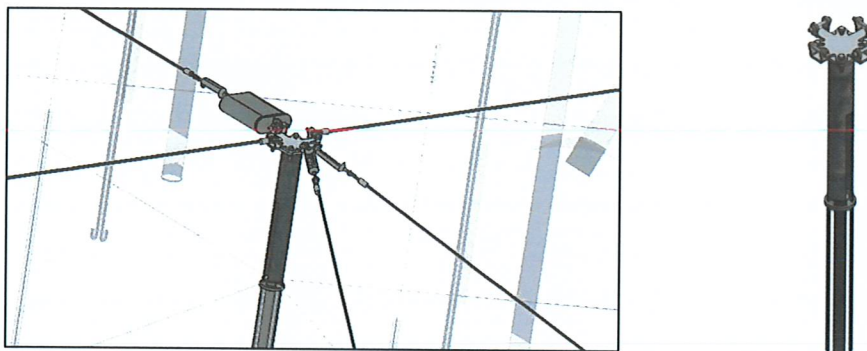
Dispositivo de anclaje e instalación en cubierta (alternativa 2).
